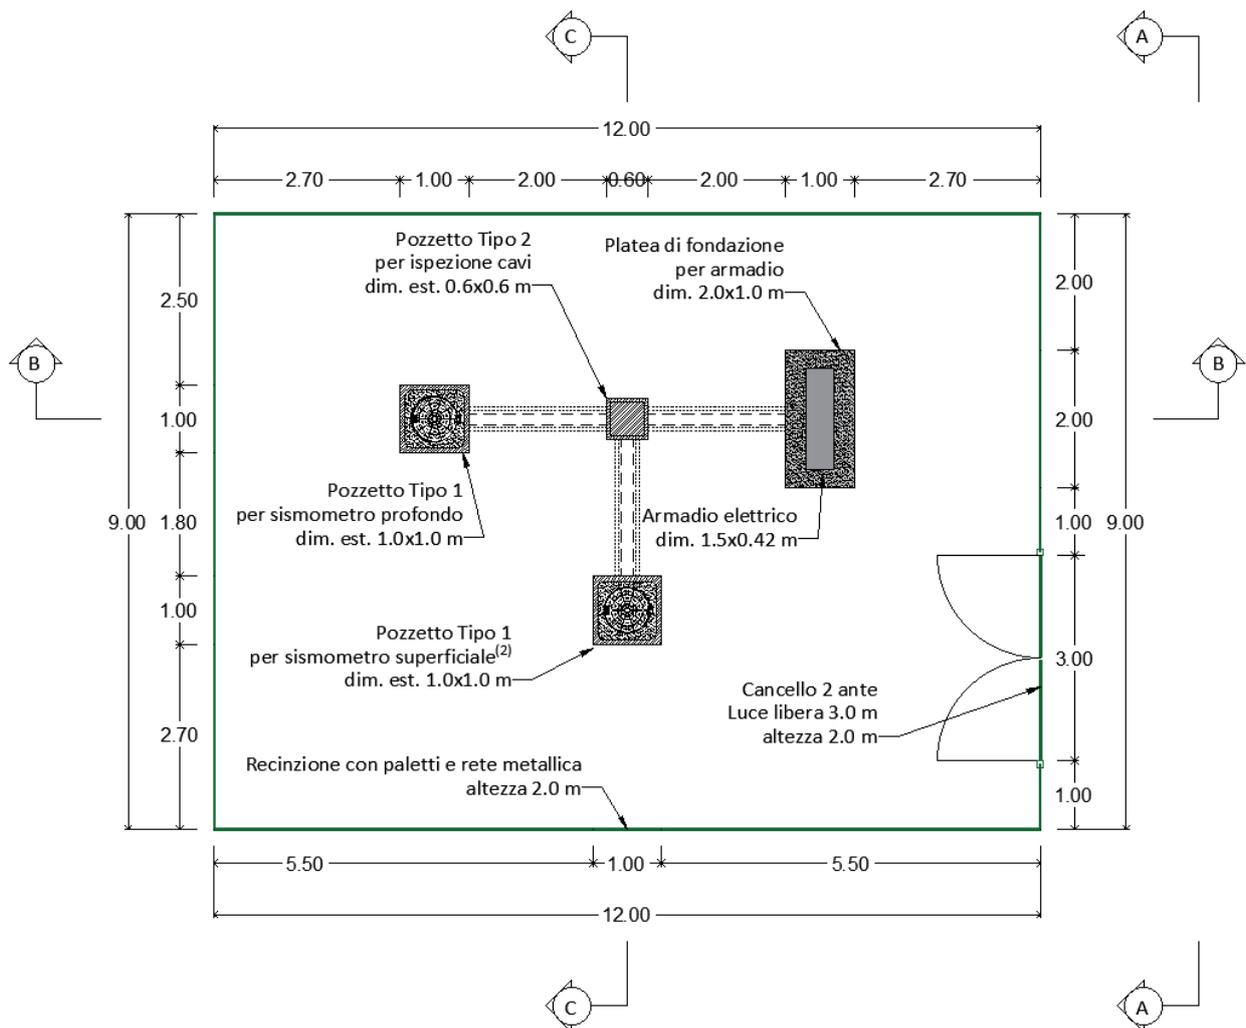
Planimetria di dettaglio delle opere superficiali (estratto ET_TAV09)
